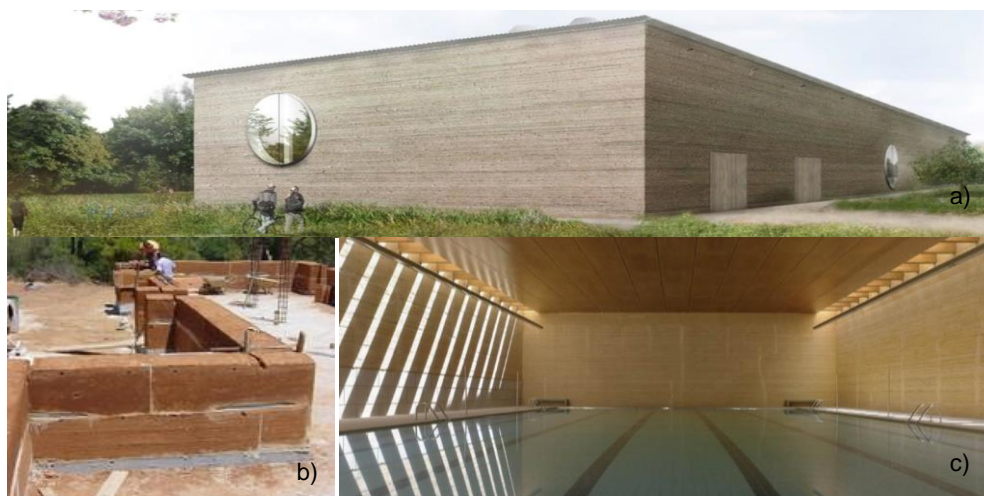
Exemplos de construção em taipa: a) Novo edifício da empresa Ricola, Suíça (2012). (Rael, 2009). b) Parede de taipa em construção. c) Piscina coberta com paredes exteriores em taipa à vista, Espanha (2007) (Empresa Betão e Taipa, Lda).
